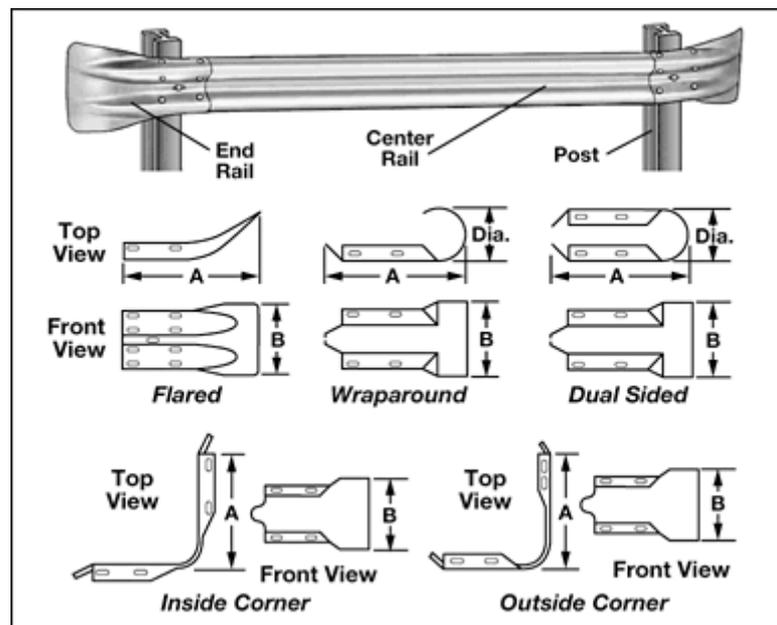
Detalhes de um guard rail (foto ilustrativa).
